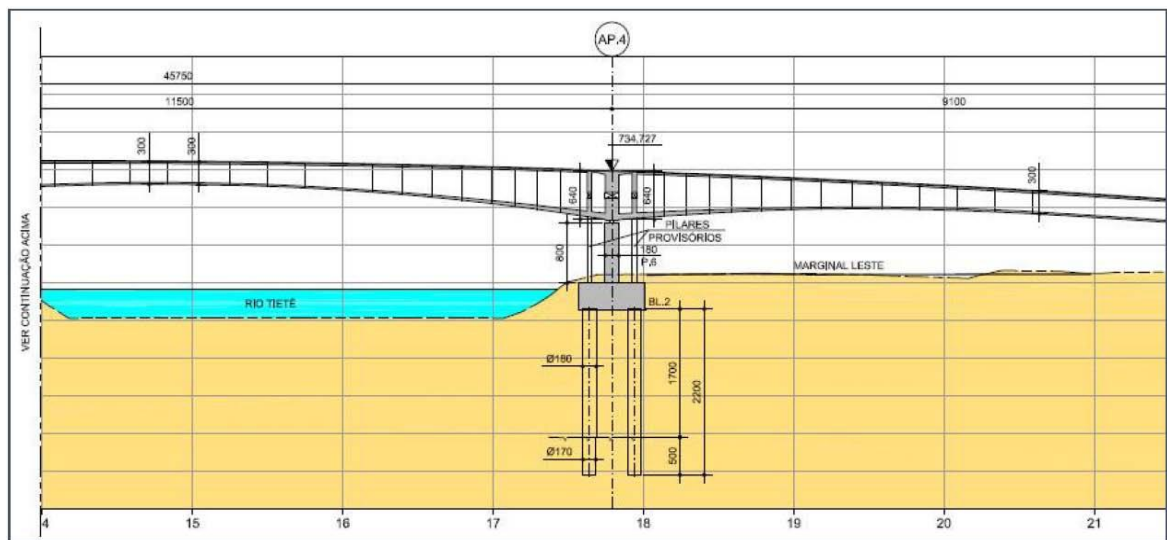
Perfil longitudinal da OAE – pista esquerda 3/4.
